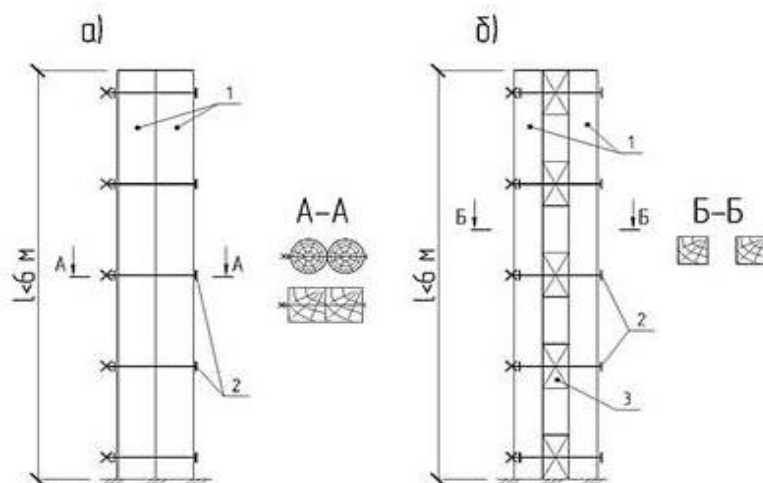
Складені брущаті стойки: а – суцільні; б – наскрізні з прокладками; 1 – бруси; 2 – болти; 3 – прокладки
